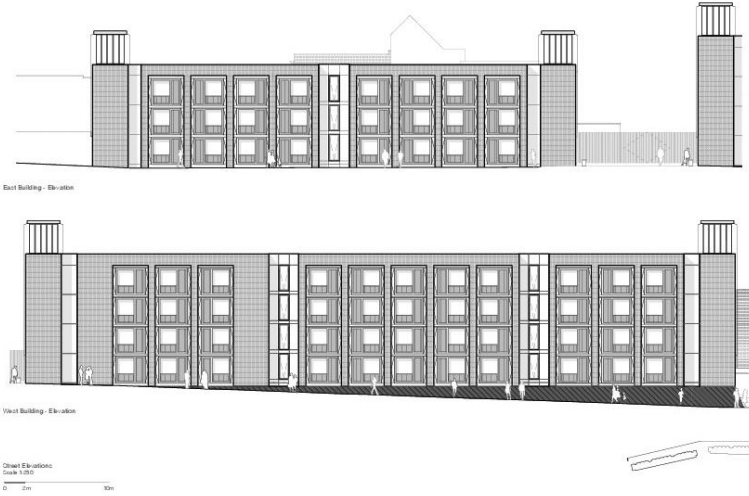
Elevación Este y Norte, FUENTE: Arch Daily
